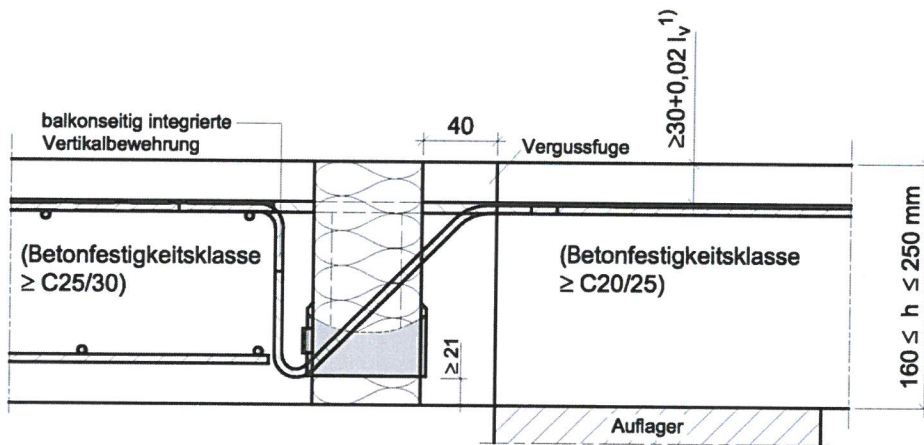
Schöck Isokorb Typ RK-240 in eingebautem Zustand mit Vergussfuge
